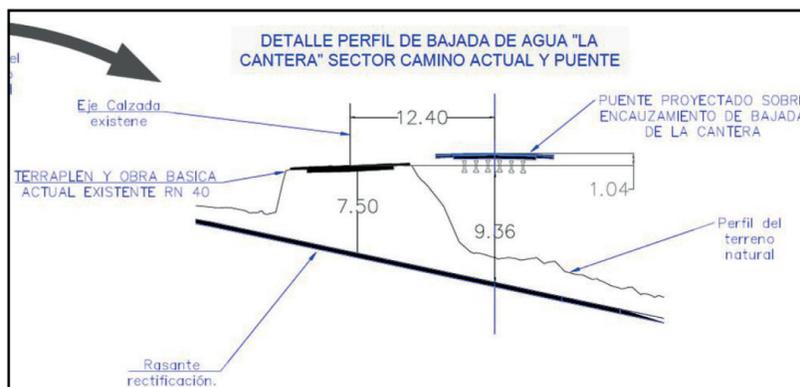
Detalle del perfil transversal de la solución prevista para Arroyo "La Cantera"
